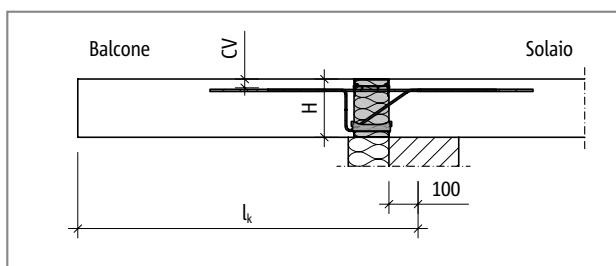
Schöck Isokorb® tipo KXT: schema statico
